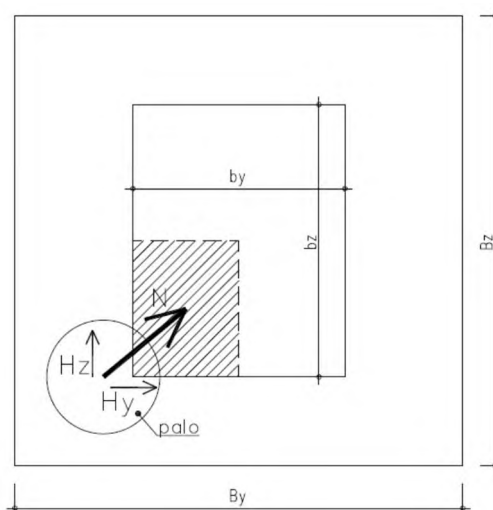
Individuazione qualitativa in pianta del puntone
